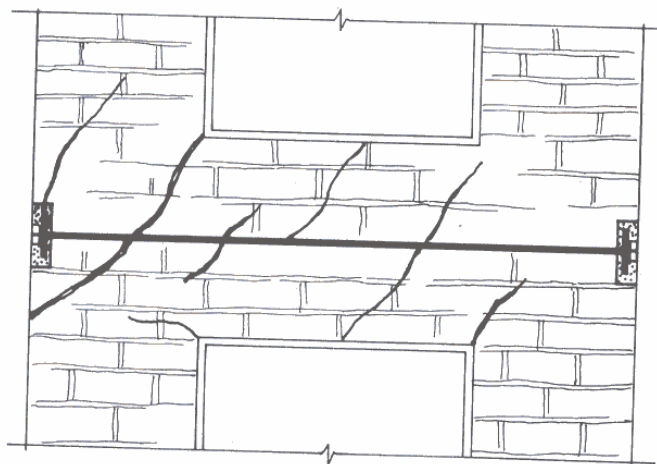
Reforço de alvenaria estrutural com tirante de aço.
